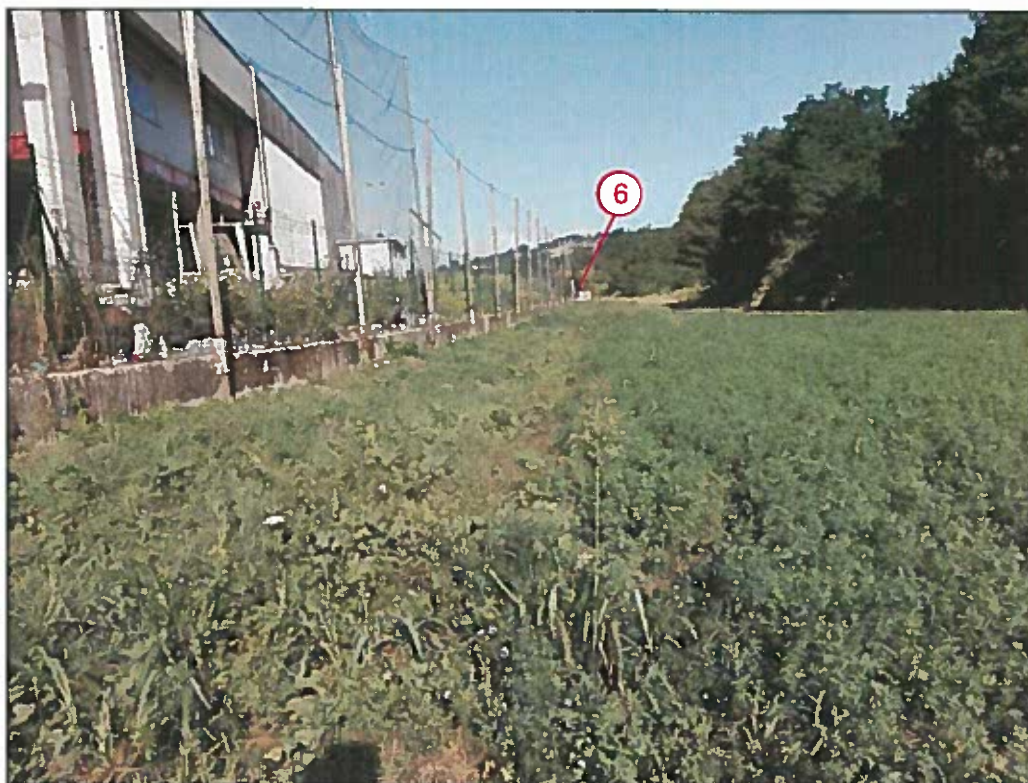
Muro oggetto di demolizione e rifacimento su pali - lato nord
